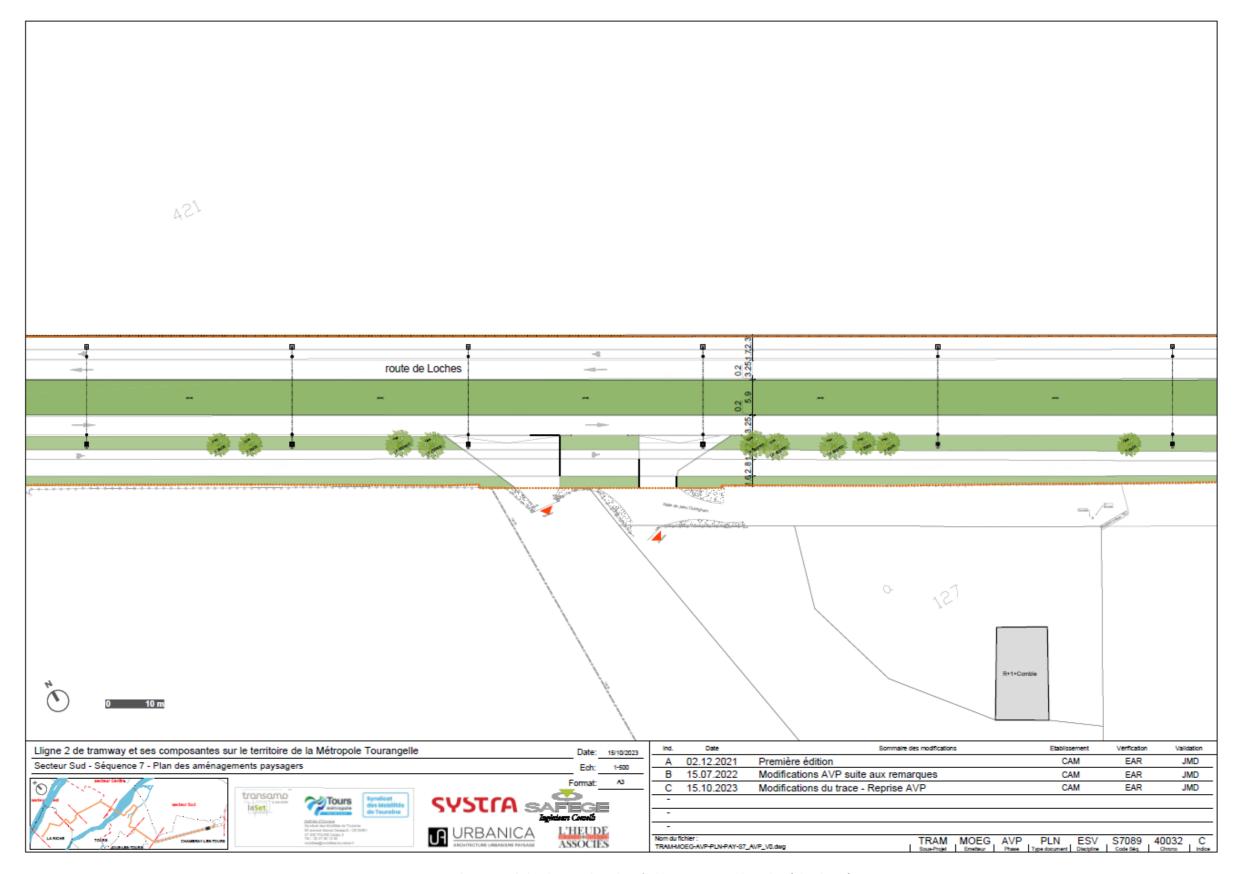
plan masse de localisation des arbres à abattre sur route de Loches (planche 17)
